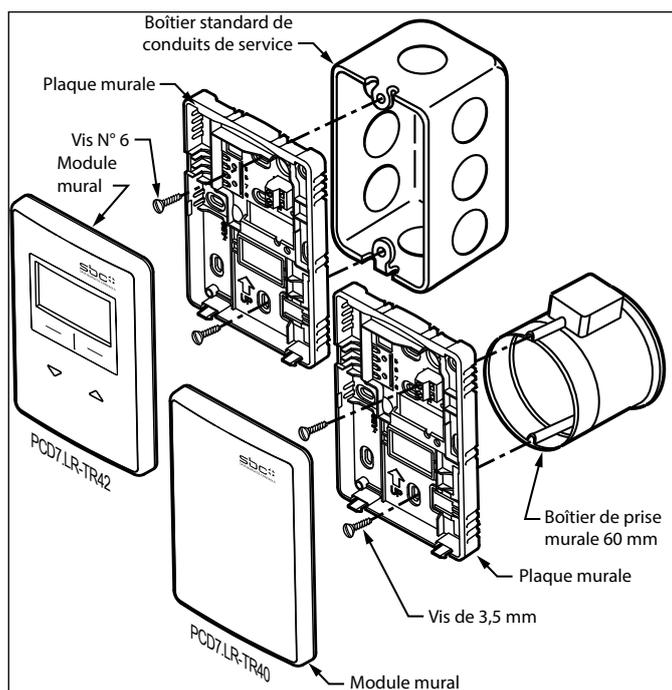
Montage sur boîtier standard de conduits de service ou boîtier de prise murale de 60 mm
